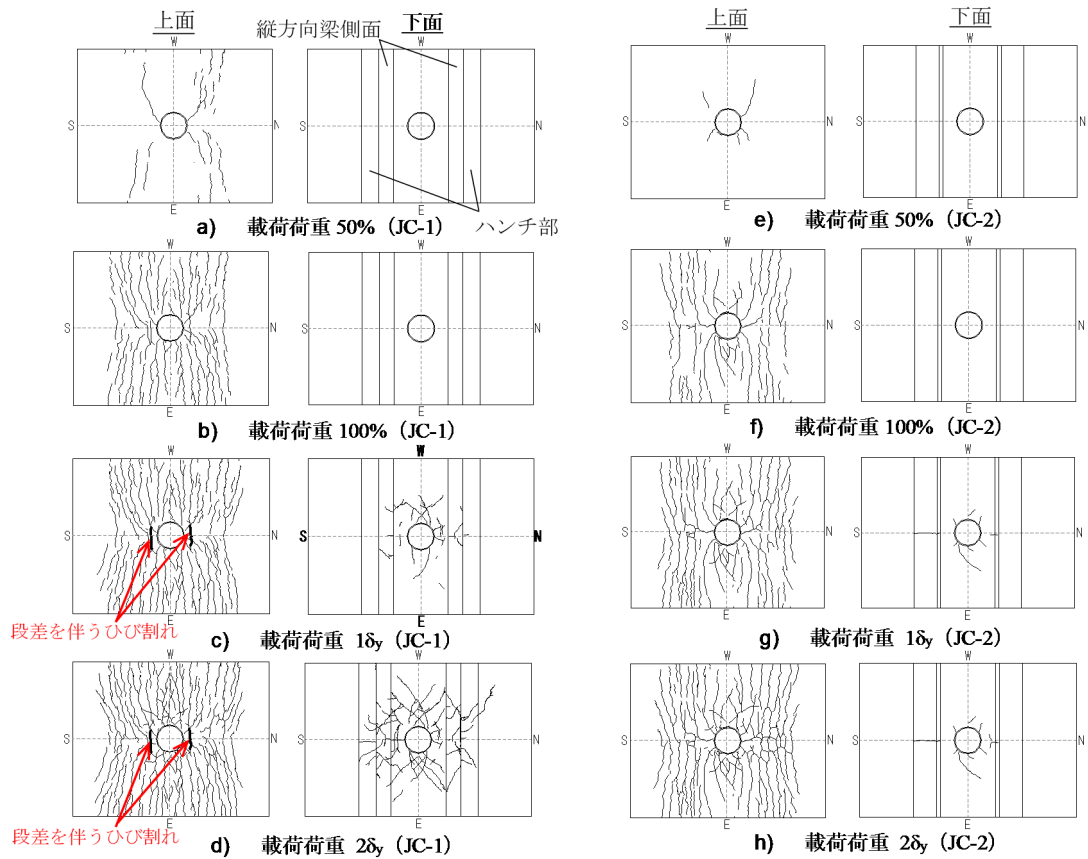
載荷荷重毎のひび割れ図
